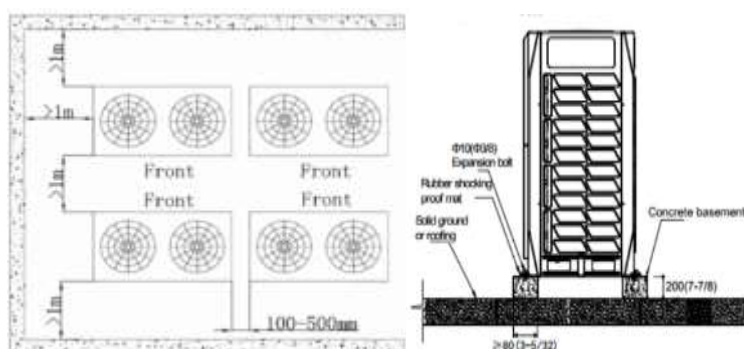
Imagen de la izquierda es una vista de planta y la imagen de la derecha es una vista de corte lateral.
